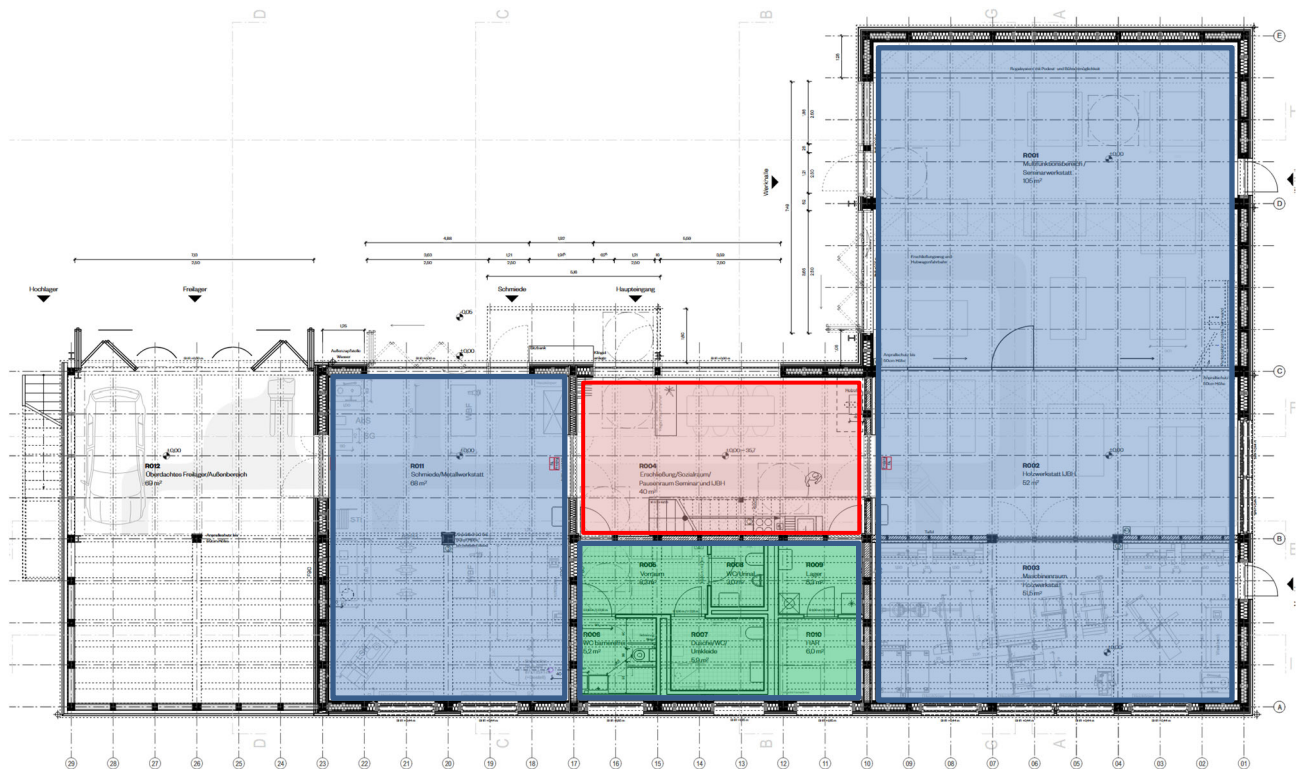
Grundriss EG mit Nutzungseinheiten
